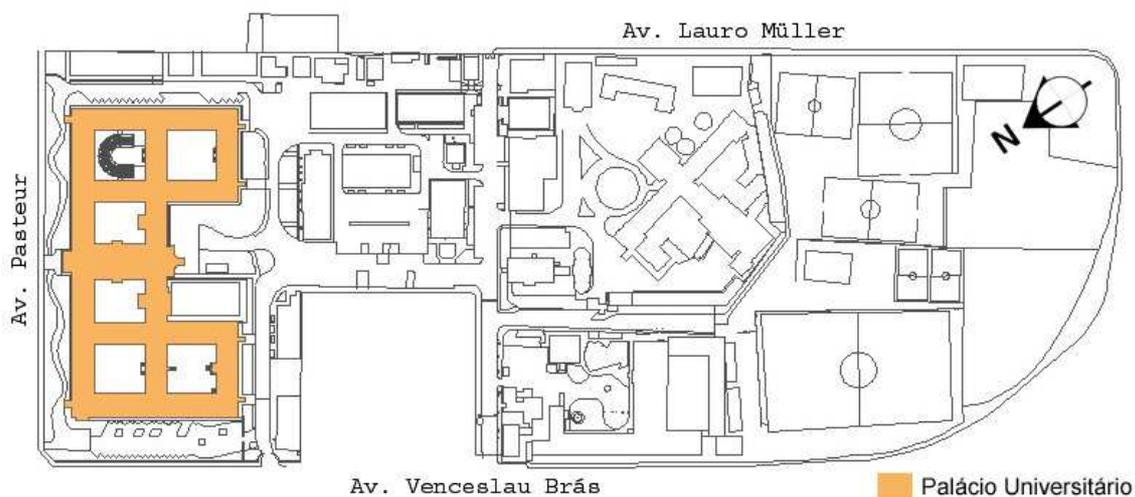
Planta de situação do Campus da Praia Vermelha.
